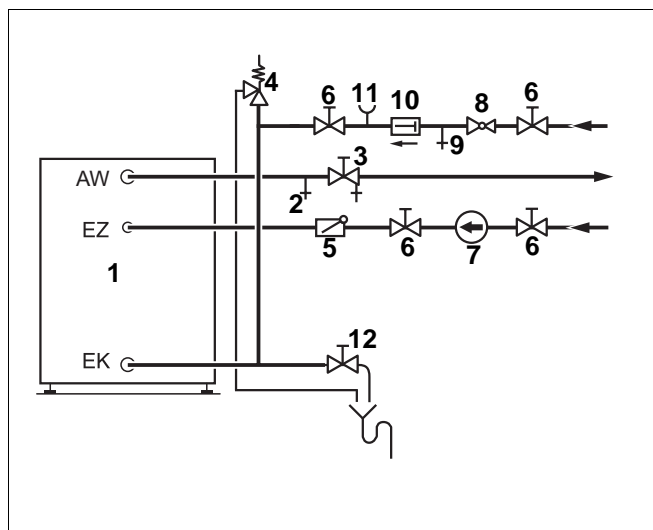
Installazione secondo la norma DIN 1988 (illustrazione schematica)
